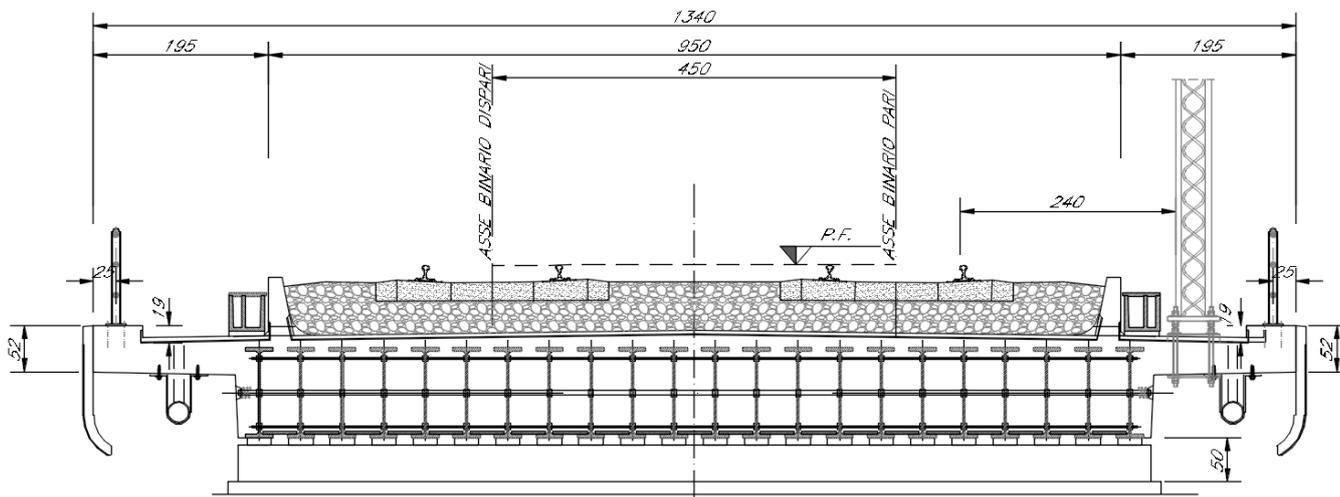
Sezione trasversale dell'impalcato a travi incorporate
